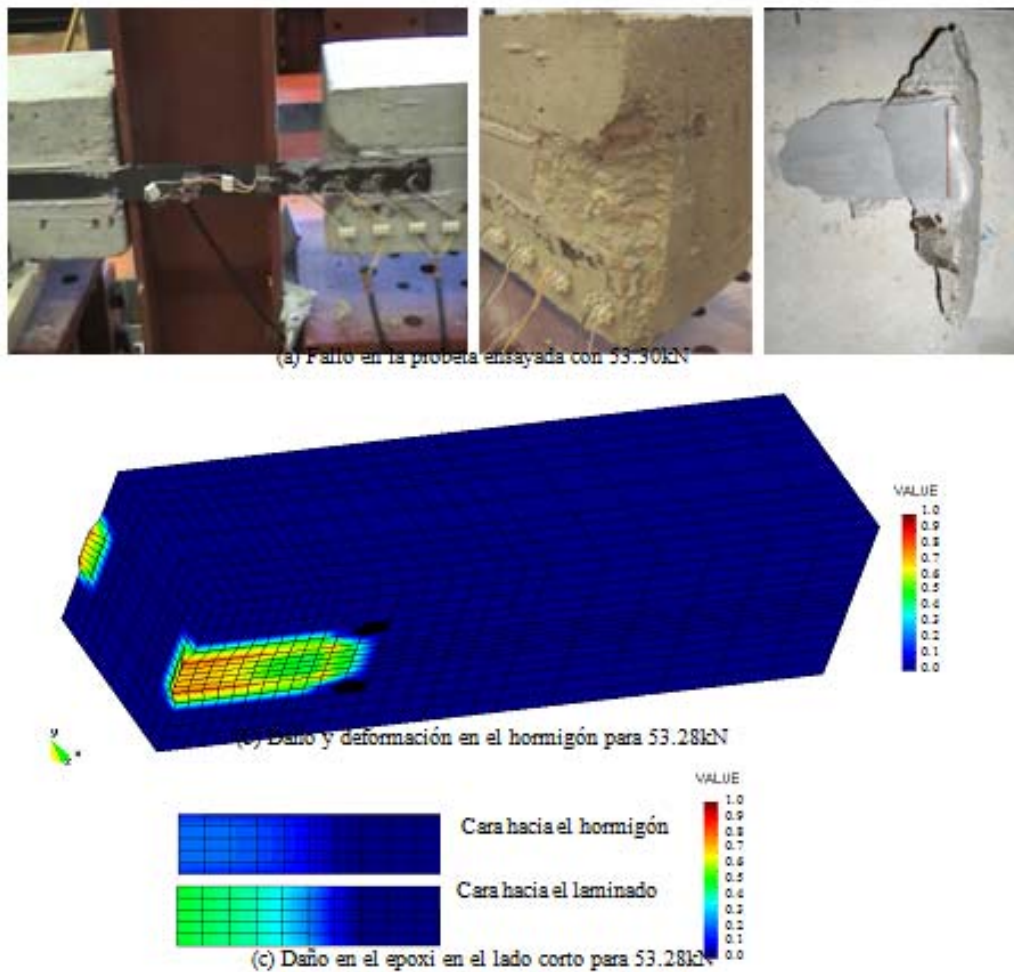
Daño en el bloque de hormigón y en el adhesivo
